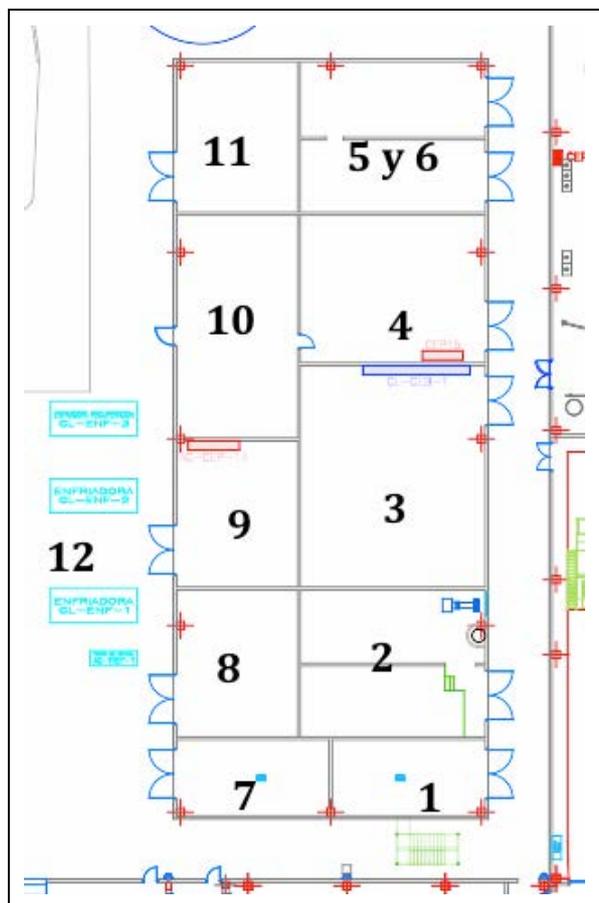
Plano detalle de la zona de instalaciones. [Fuente: Elaboración propia]
